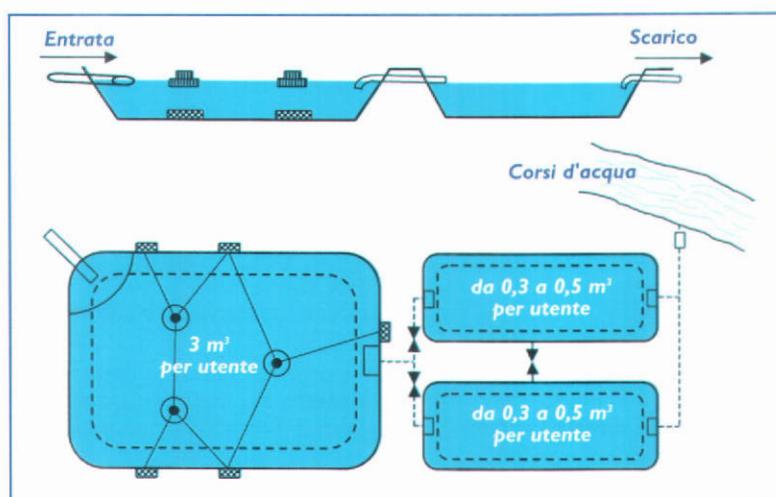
Schema raffigurante il principio di funzionamento di una laguna aerata
